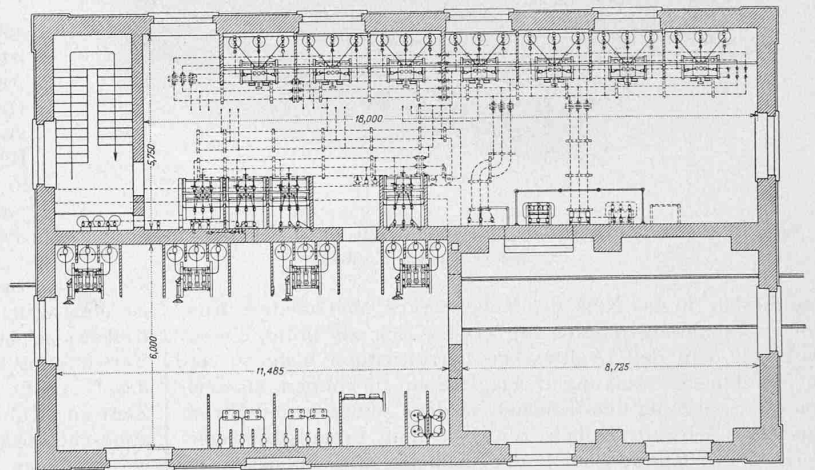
Grundriss vom I. Stock. — Masstab 1 : 200.
